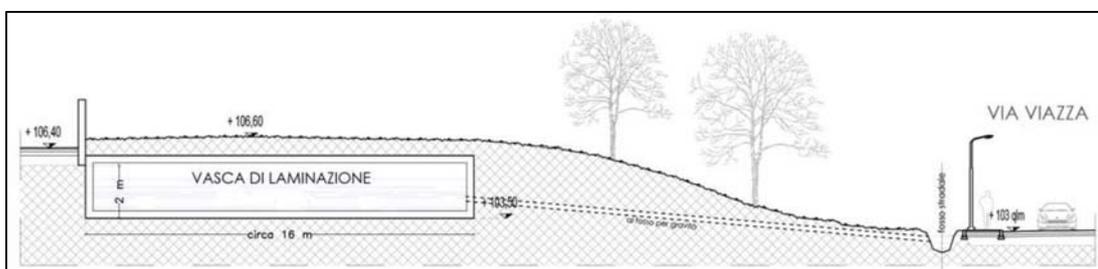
Sezione della vasca di laminazione prevista a servizio del “bacino ovest”.
